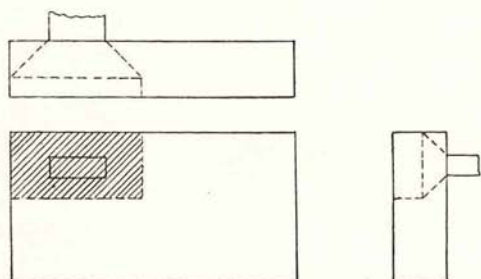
Tryk på fundament. Rimelig tilnærmelse.
